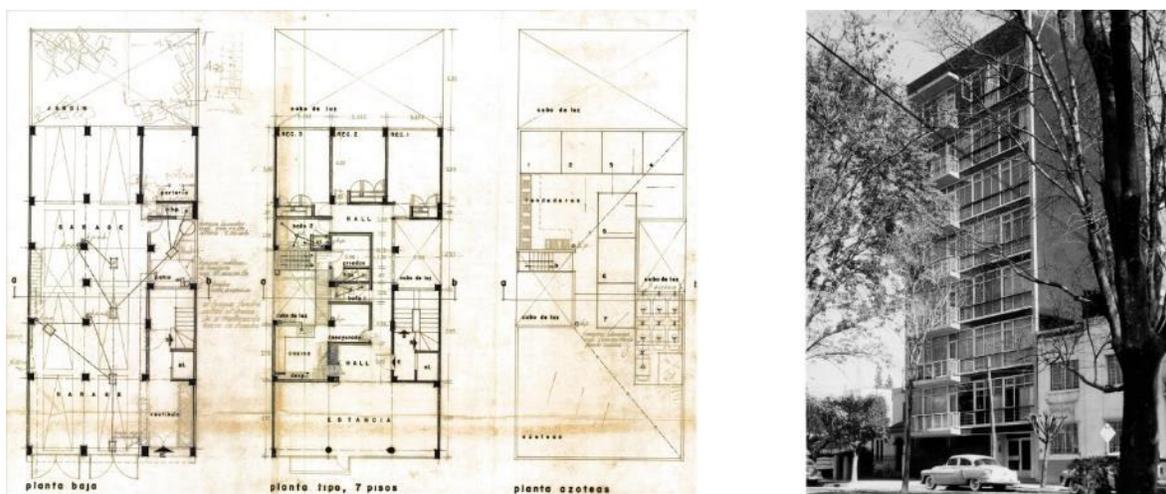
Planos de la planta baja, tipo y azotea, julio 1953 y vista de la fachada del edificio ubicado en Ámsterdam núm. 122, fotografía A. Escobar, diciembre 13, 1954
